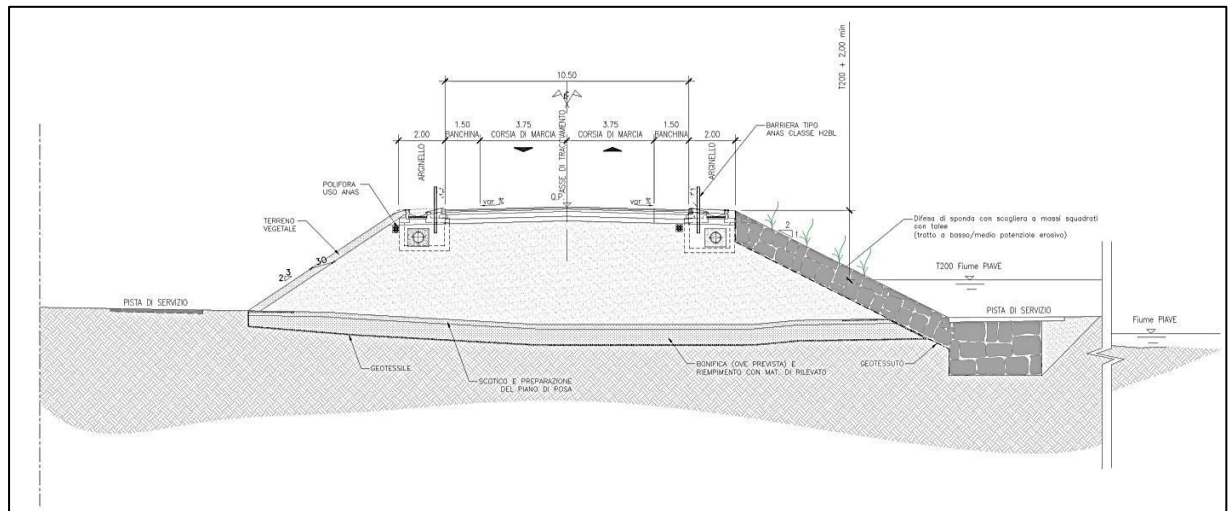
Sezione tipo C1 con difesa spondale a massi tratto a basso/medio potenziale erosivo.
